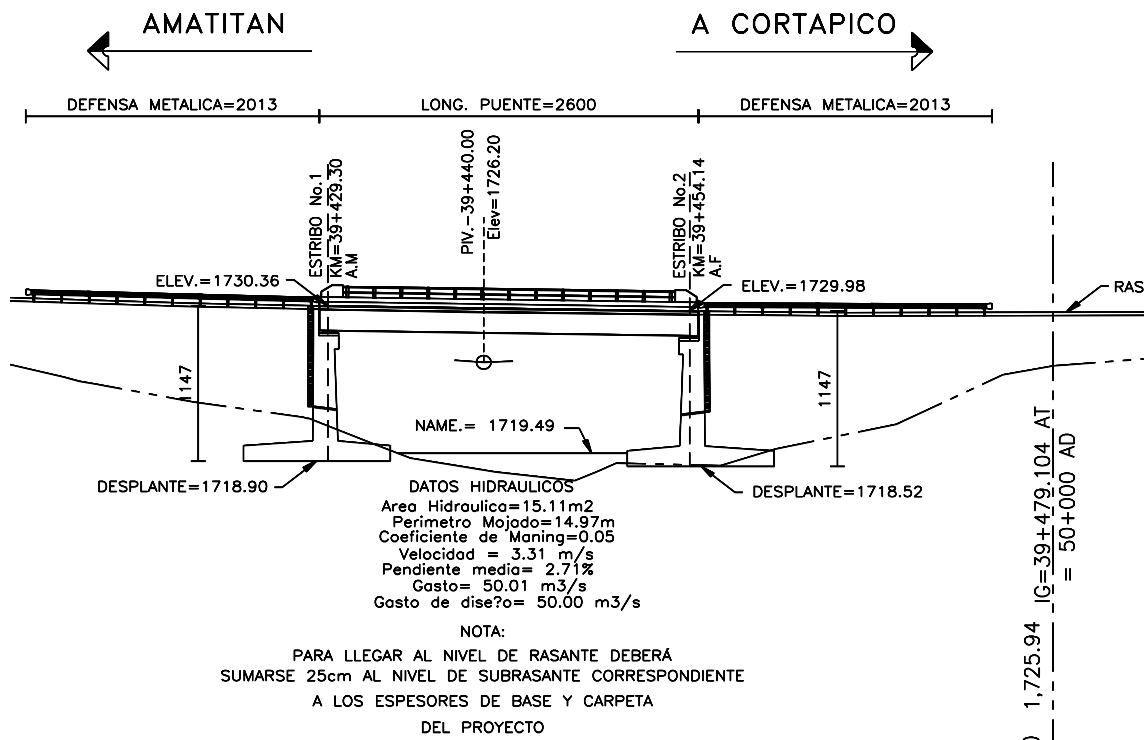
Planta general propuesta del proyecto (Vista Frontal)
